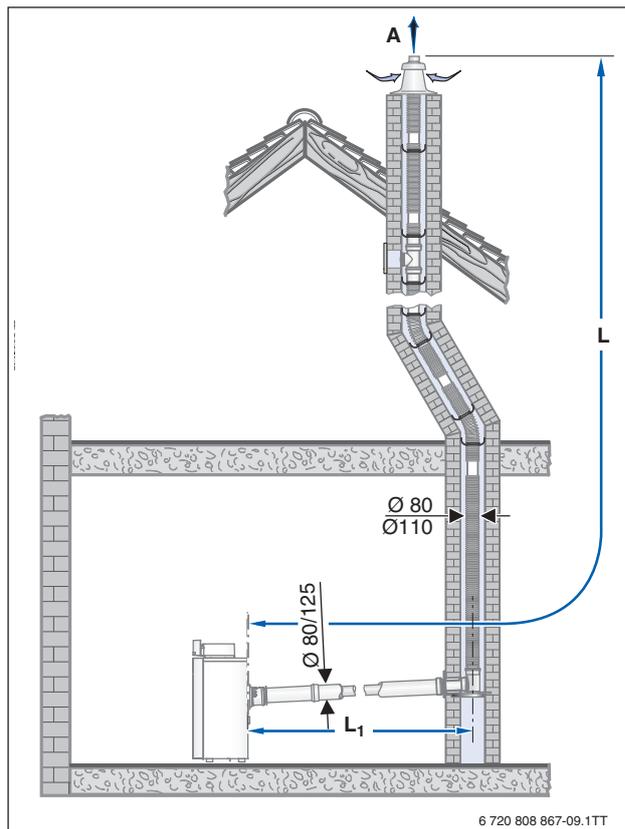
Montagevarianten mit dem Bausatz GA-K + ÜB-Flex
